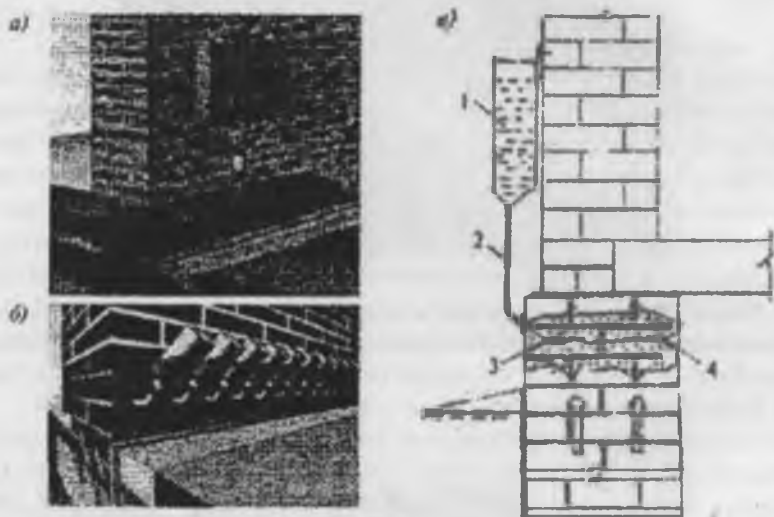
Схемы восстановления горизонтальной гидроизоляции стен путем инъектирования изолирующего состава в швы кладки:
